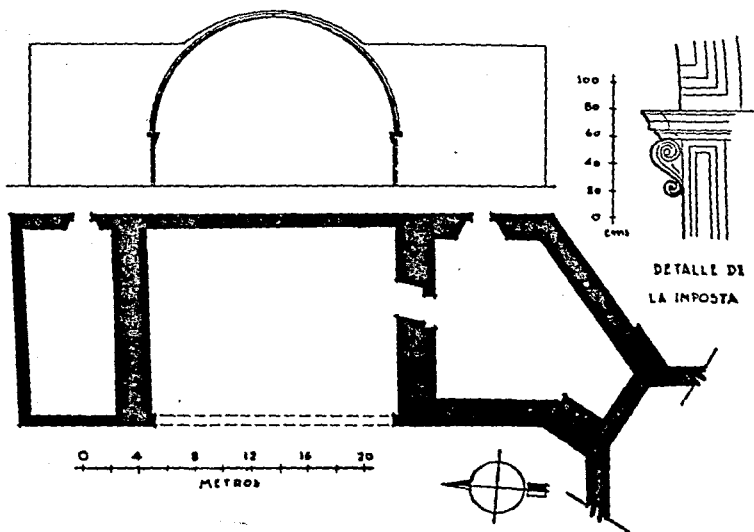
Actopan, capilla abierta, planta y fachada basadas en Azcúe y Mancera.
